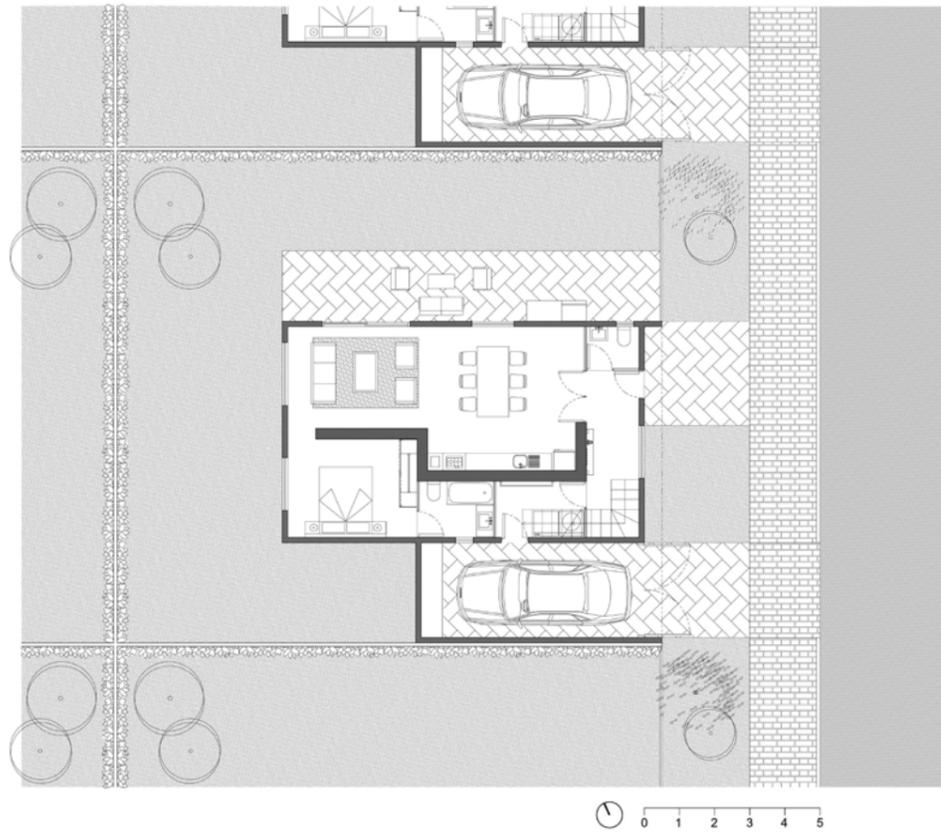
Planimetría Vivienda Propuesta Emplazada en Terreno Formulación Propia
